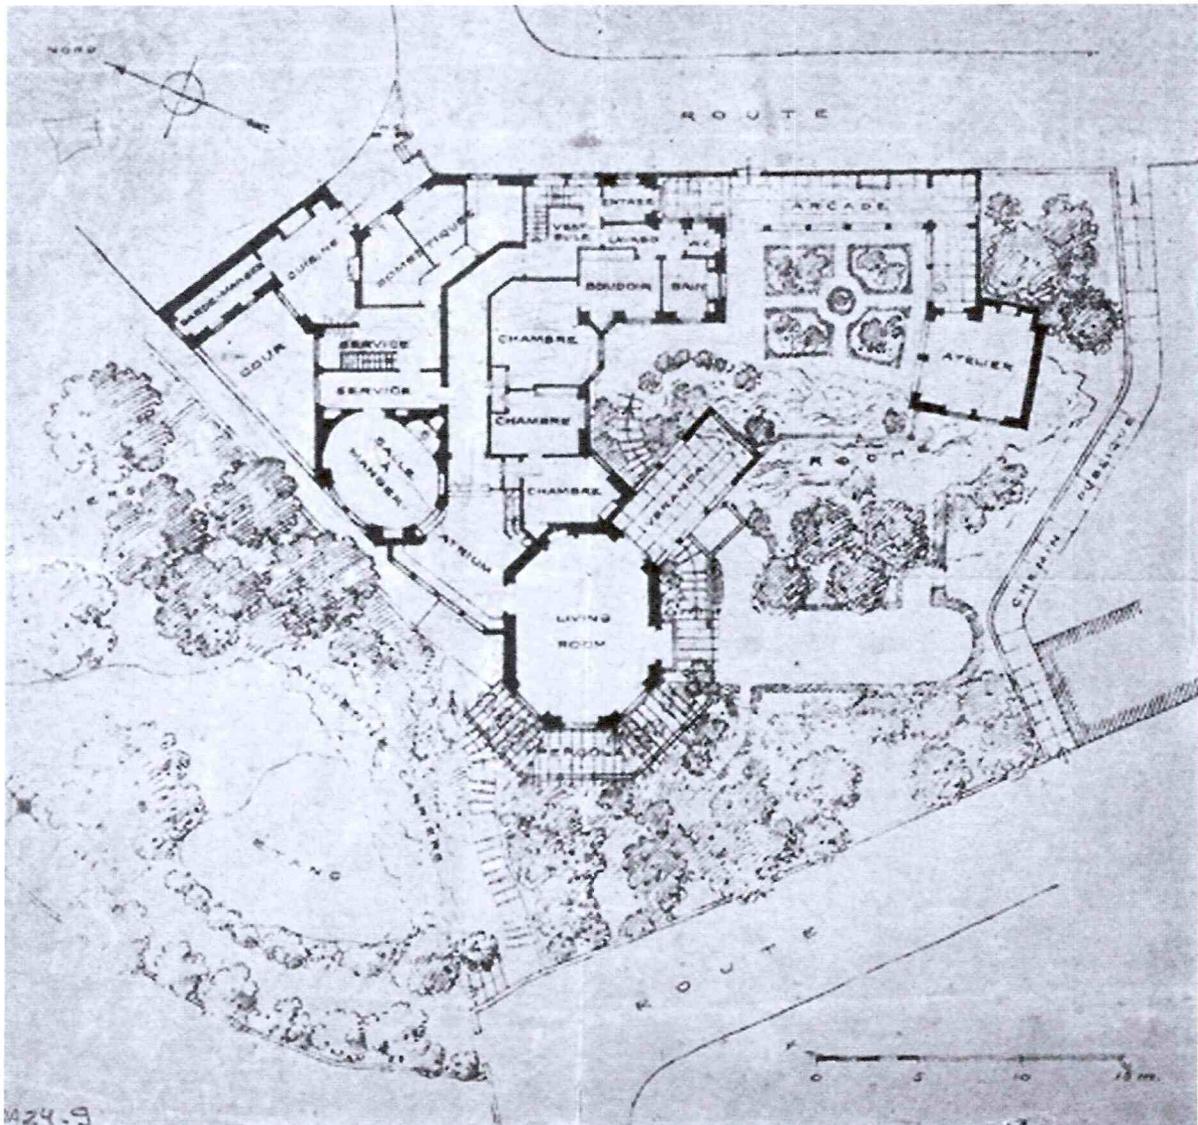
Casa do Cipreste, Sintra, Portugal. Planta.
